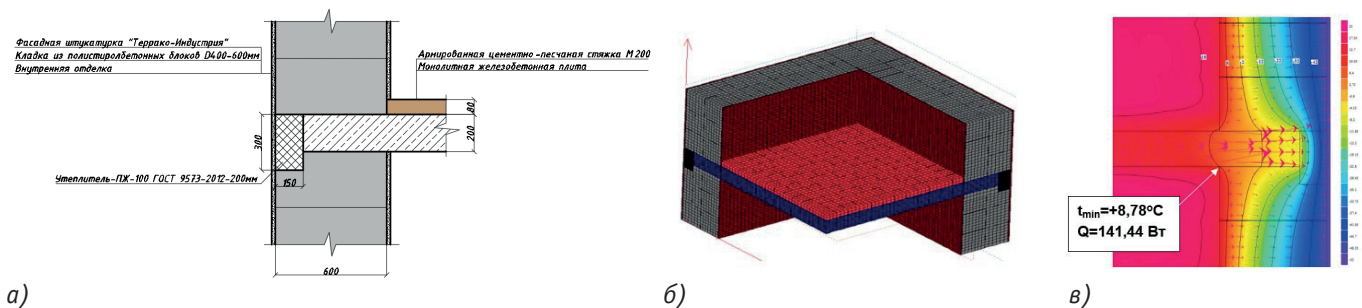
Результаты теплотехнического расчёта углового участка примыкания наружной стены к междуэтажному перекрытию при широкой теплоизоляции торца плиты: а) конструкция узла; б) расчётная модель; в) температурное поле в вертикальном разрезе по внутренней плоскости стены. Составлено авторами по результатам теплотехнических расчётов
